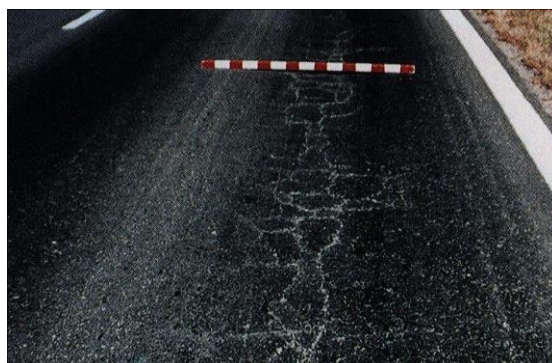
Fissuration d'une chaussée bitumineuse par fatigue (photo LCPC, 1998)
